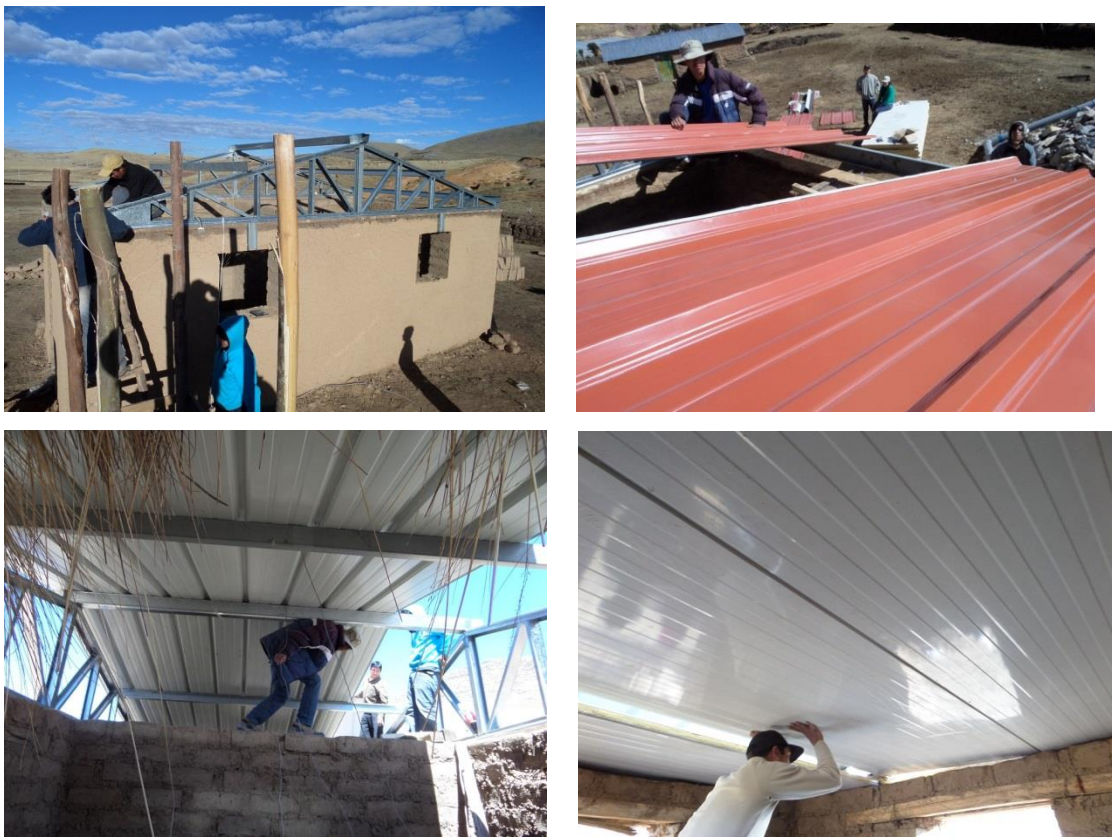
Las imágenes ilustran el montaje de la estructura, planchas de cubierta y cielo raso del techo.
